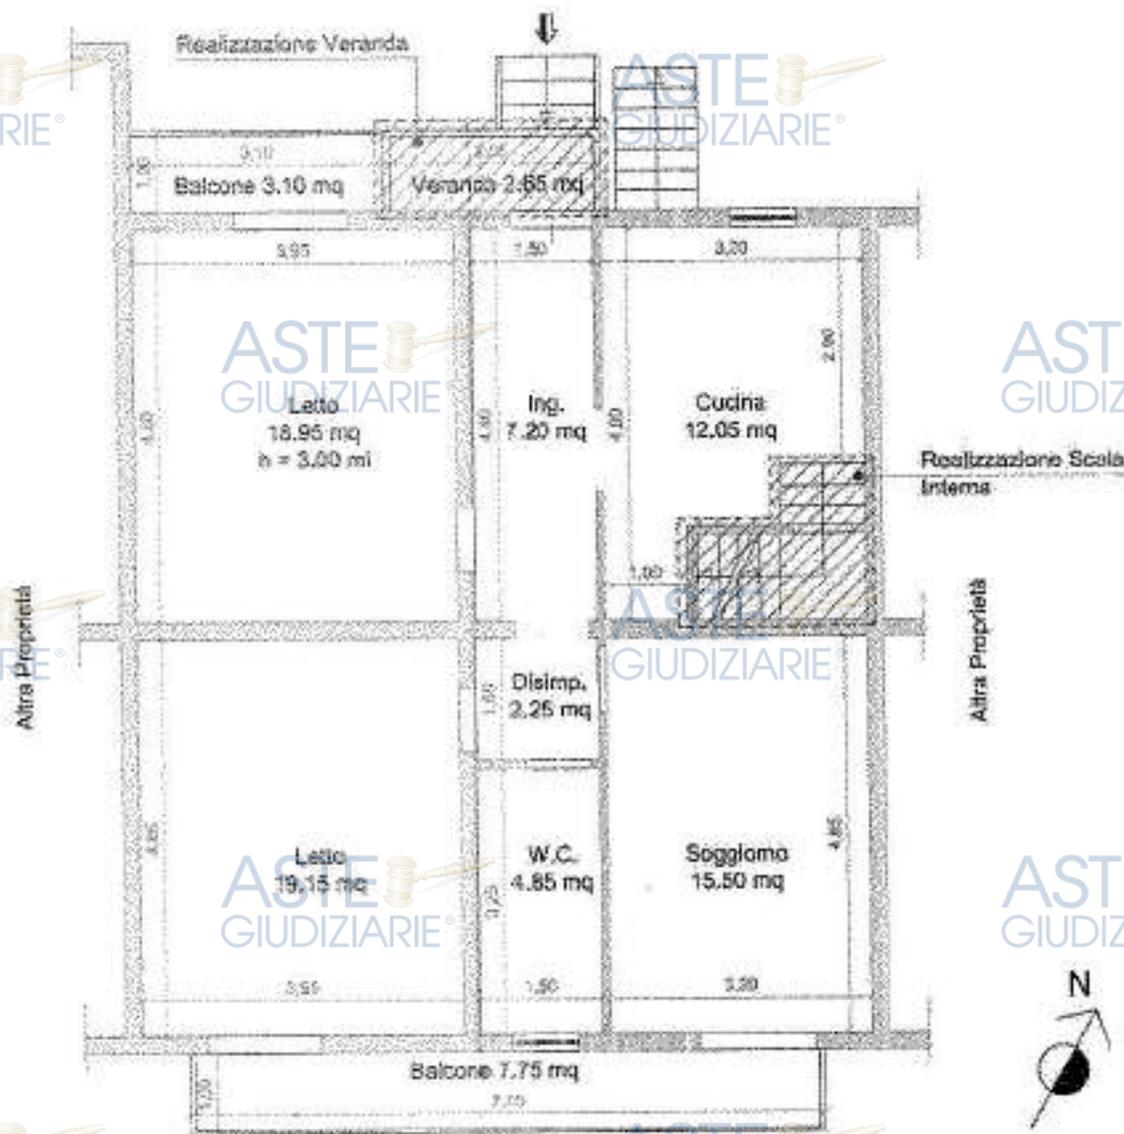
Planimetria Stato di Fatto Piano Terra.
